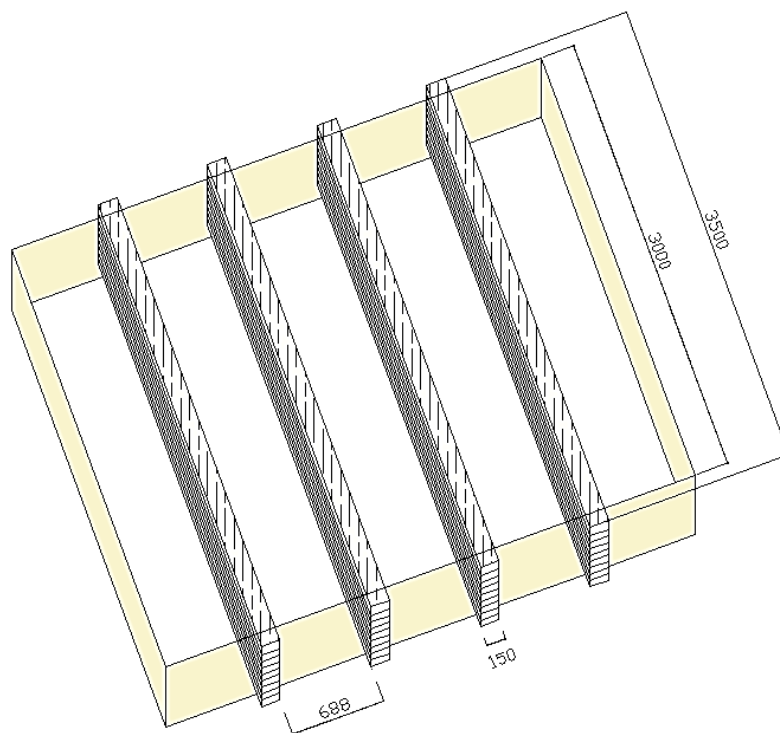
Layout do posicionamento de distribuição das vigas por ensaio (dimensões em mm)
